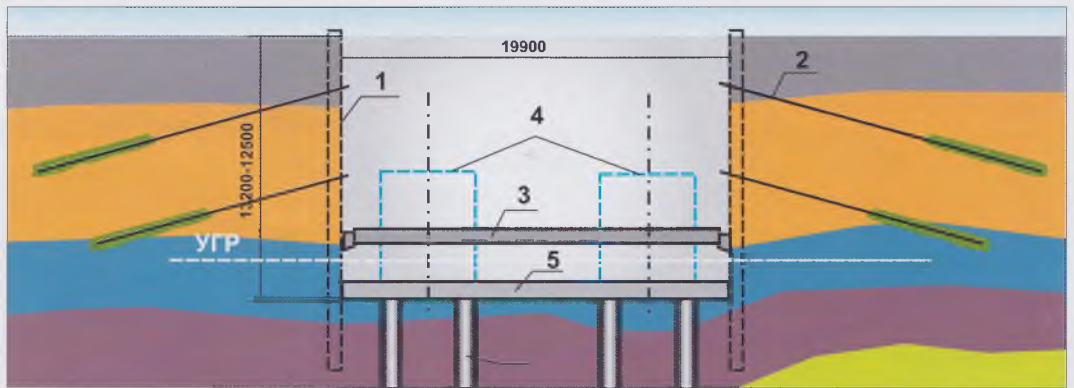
Крепление тоннеля на 1-м участке: 1 - сваи крепления котлована из двутавра 60Б1, 2 - грунтовые анкеры, временные расстрелы из трубы, 3 - контур сооружаемых тоннелей, 5 - ростверк монолитный, 6 - буронабивная свая
